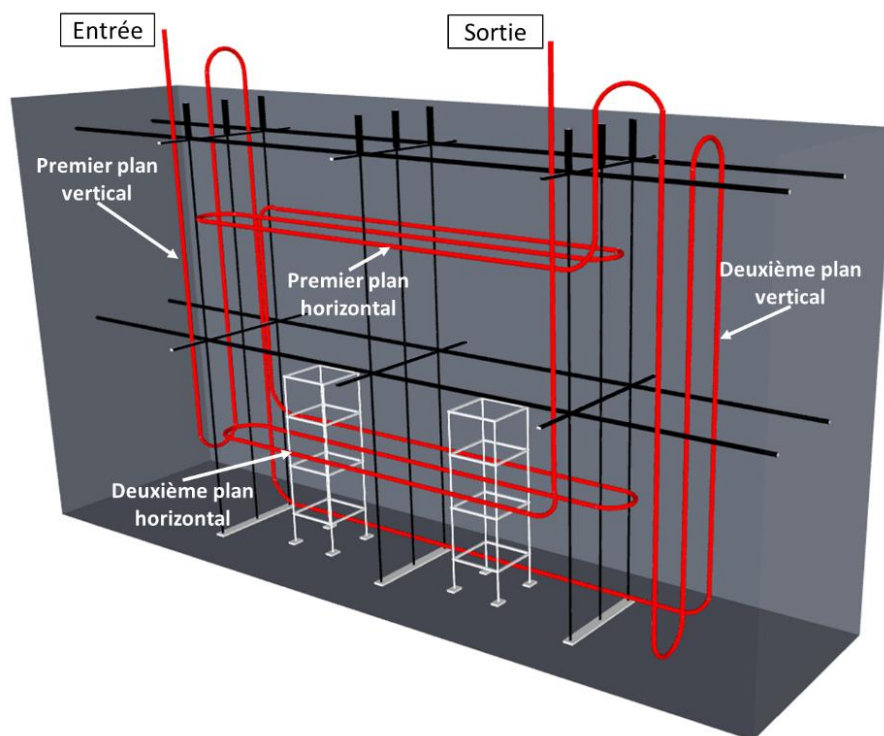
Plan d'instrumentation d'un bloc non armé par capteurs à FO noyé dans le béton.
